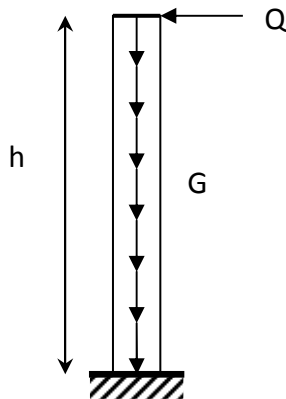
schéma statique d'acrotère. Figure III-2 : coupe verticale de l'acrotère.
